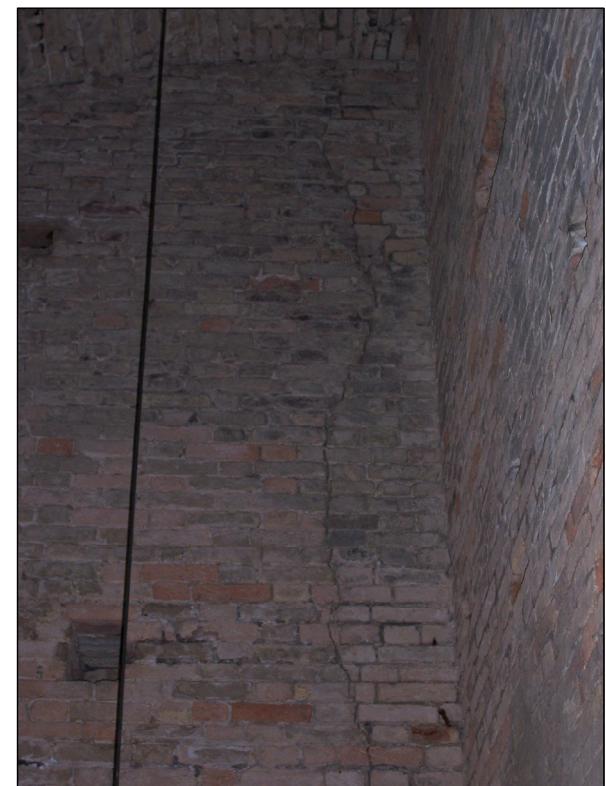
Sud, arco rampante con zona di muratura bruciata.
